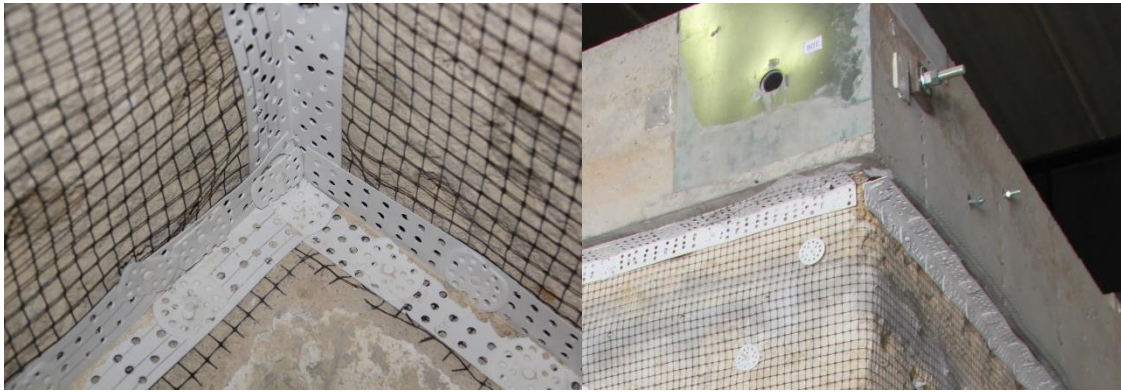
Cantoneiras aplicadas com recurso a prego e bucha plástica
